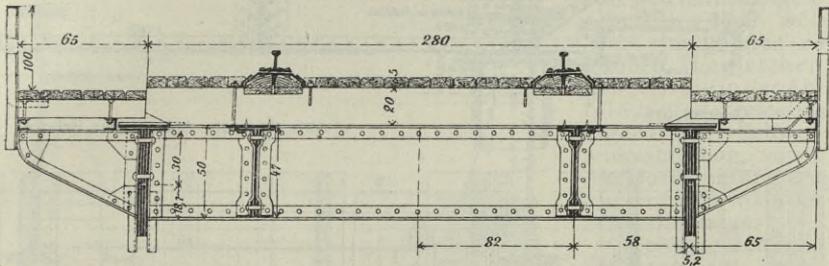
Eisenbahnbrücke mit eisernen Langschwellen. (Nach Handb. Ing.-Wiss. II, 3. Taf. VIII).
